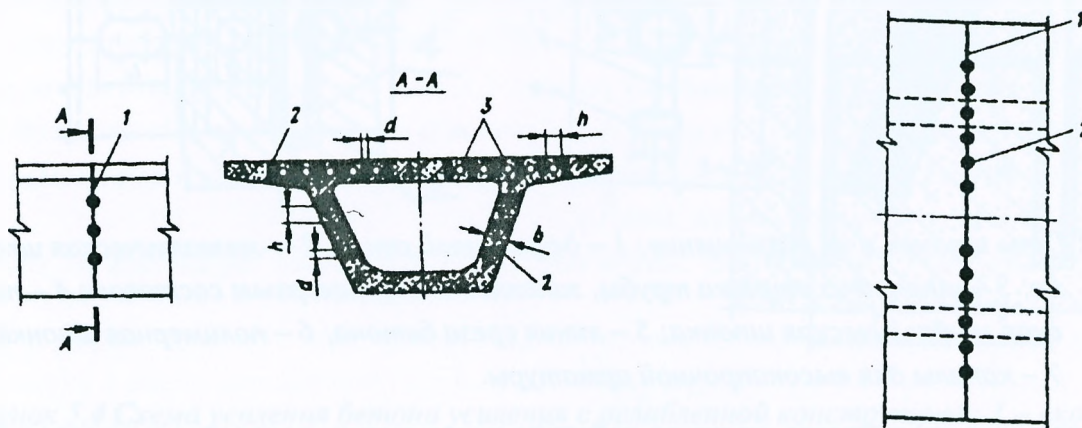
Конструкция усиления стыков установкой шпонок: 1 -- дефектный стык; 2 – шпонка (металлическая или полимерная); 3 – каналы для предварительно напряженной арматуры.
